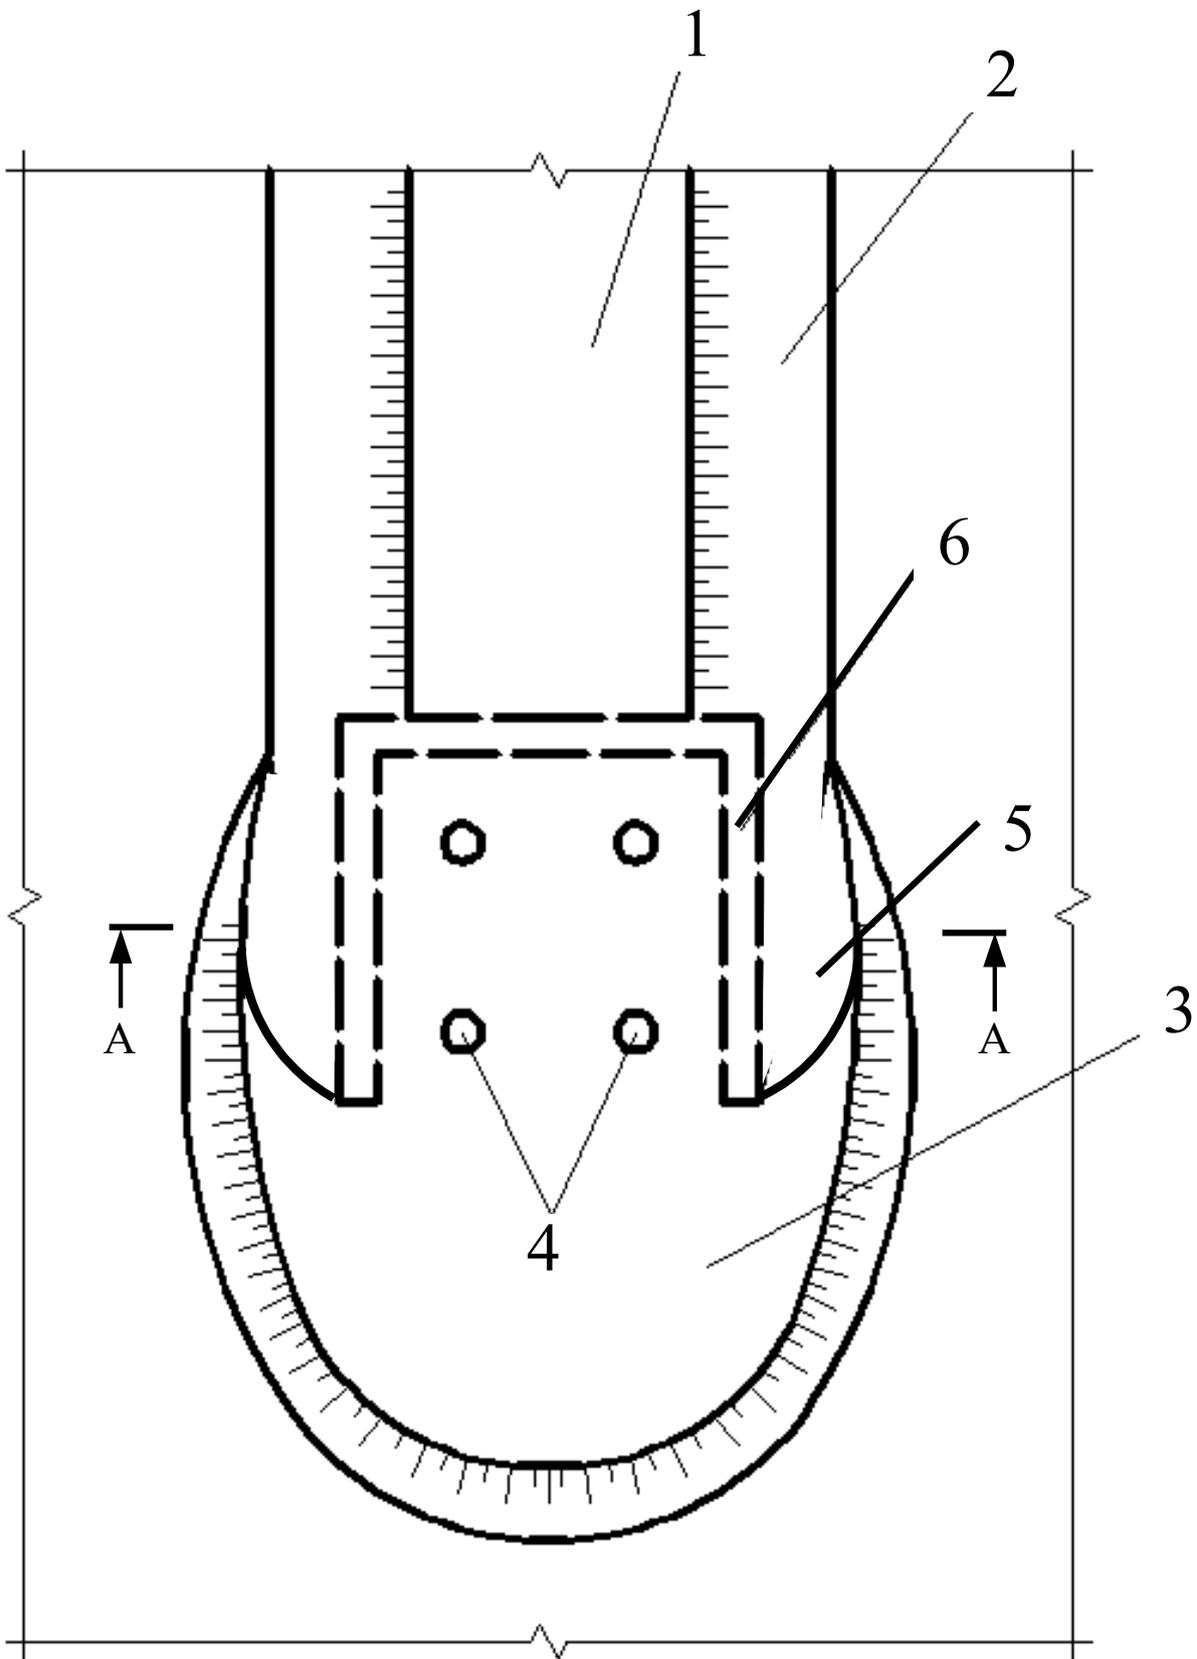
Часть мостового перехода в зоне устоя моста: 1 – основная площадка насыпи, 2 – откос насыпи, 3 – уширенная площадка, 4 – столбы фундамента устоя, 5 – боковая конусная площадка, 6 – ограждающая вертикальная стенка площадки 5
